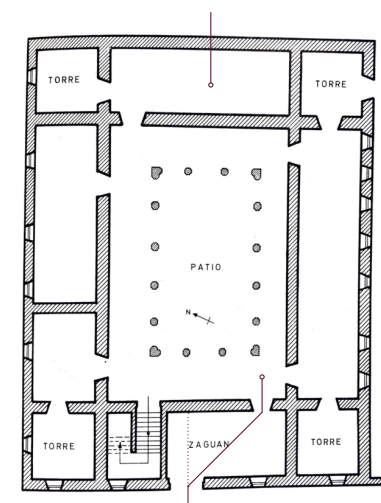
Esquema de planta baja del Palacio de los Vivero. Valladolid, S. XV
